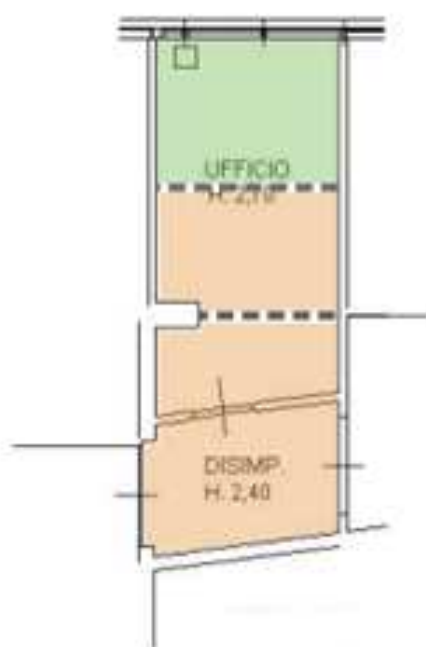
ESTRATTO ELABORATO PLANIMETRICO
